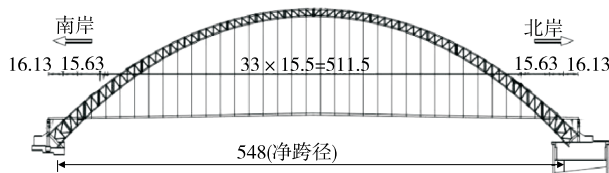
某中承式钢管混凝土拱桥主桥立面布置(单位: m)
